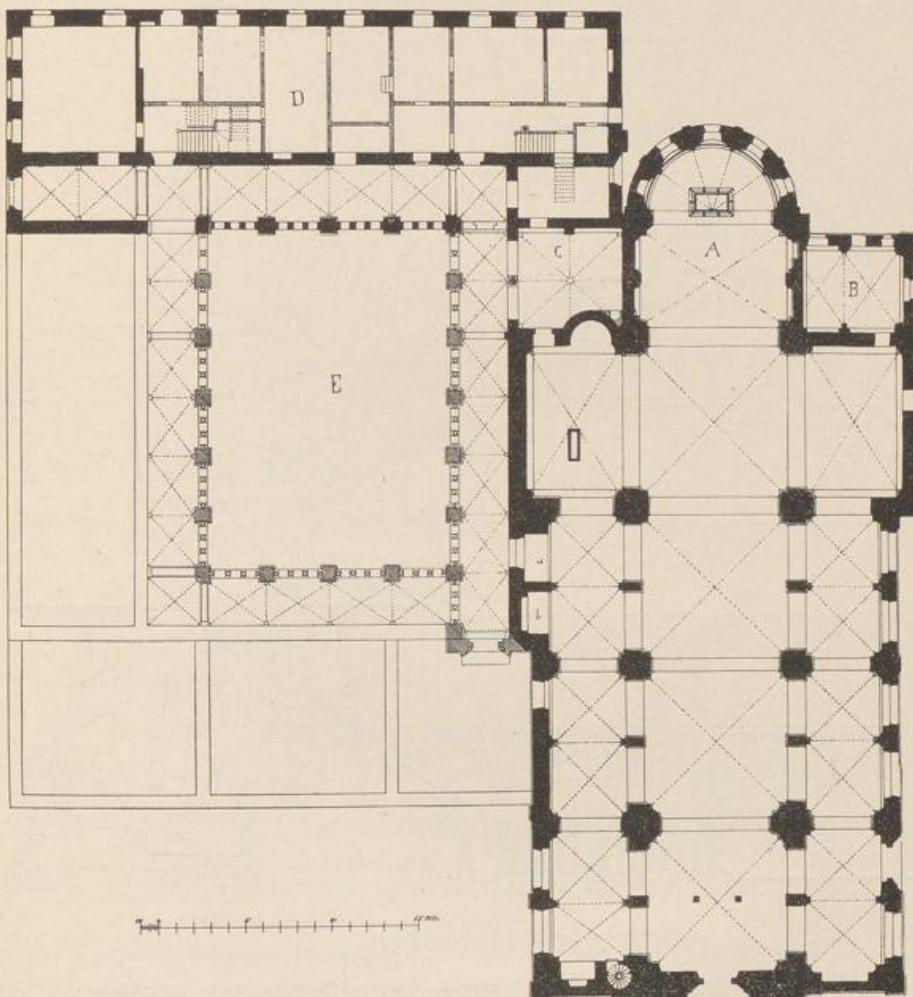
Gerresheim. Grundriss der Stiftskirche mit Kapitelhaus und Kreuzgang.
